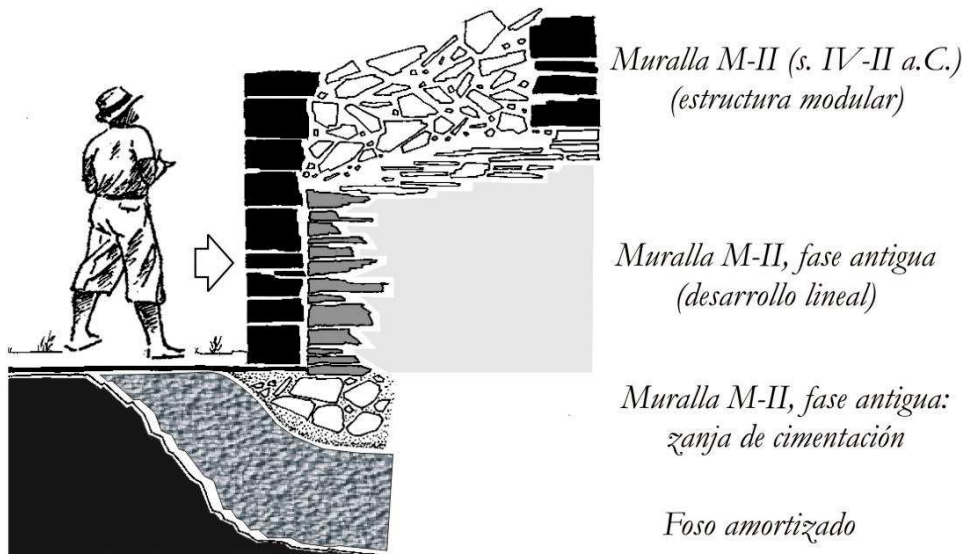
Chao Samartín. Estructura de la muralla modular del siglo IV a.C. y boceto para su instalación recubriendo otra estructura anterior.
